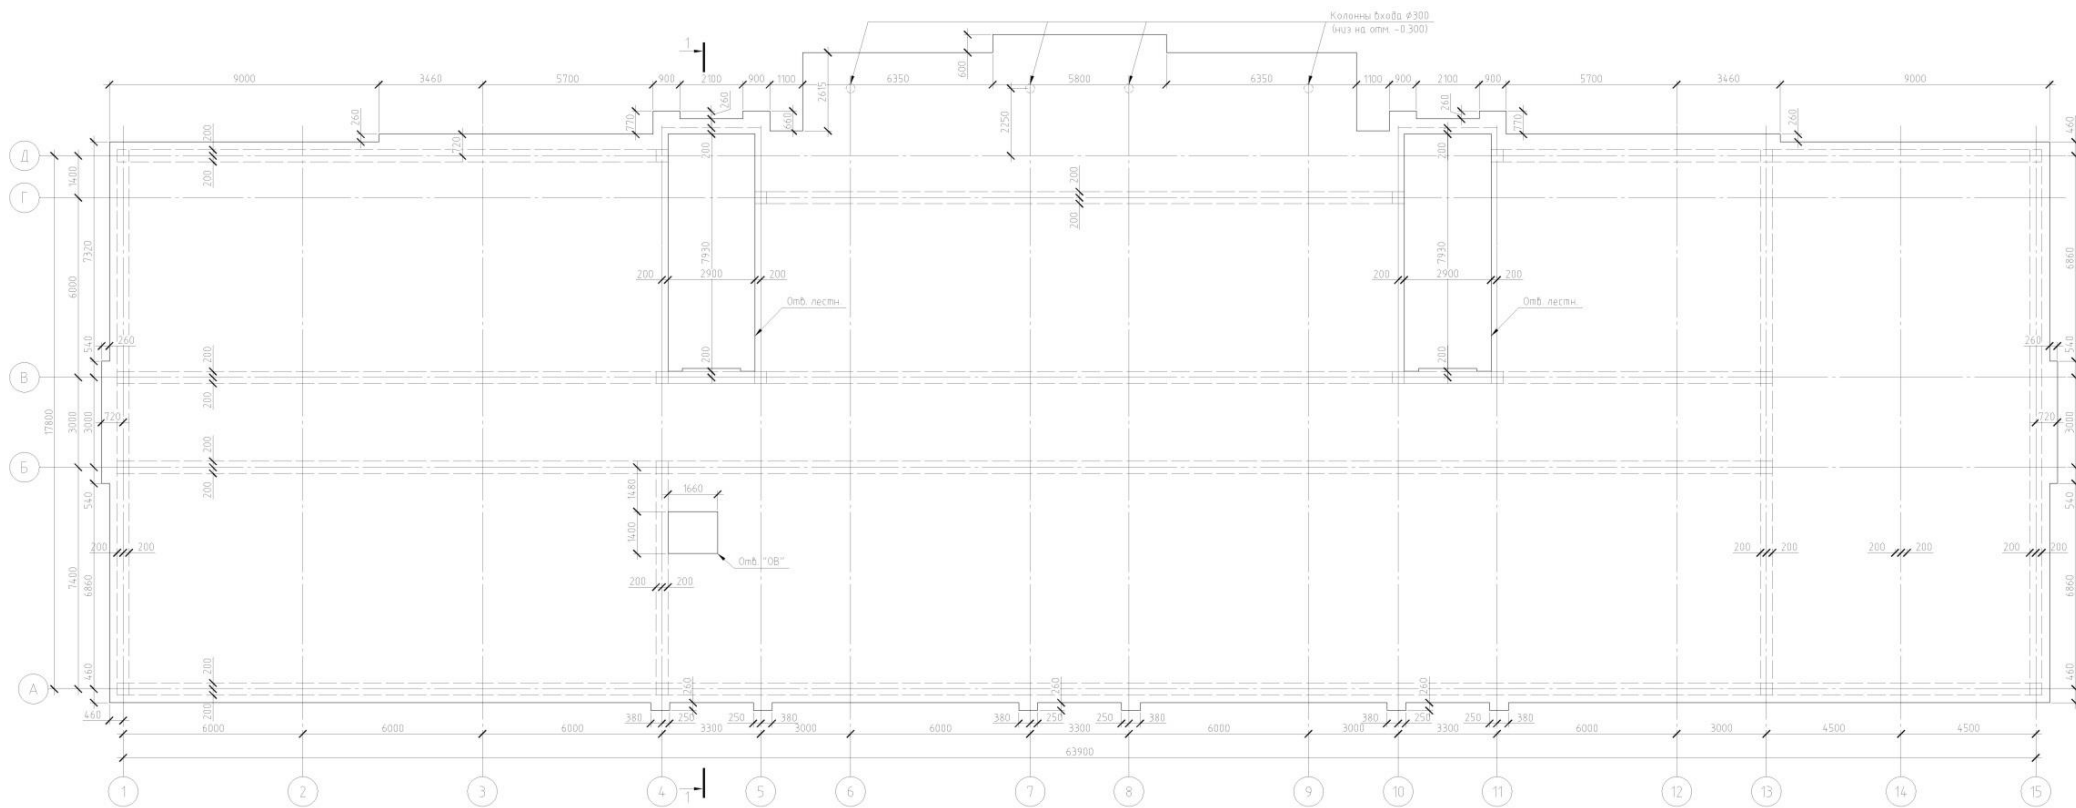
Схема расположения монолитной плиты на 1-м этаже (низ на отм. +3,300). Схема расположения монолитных балок плиты
